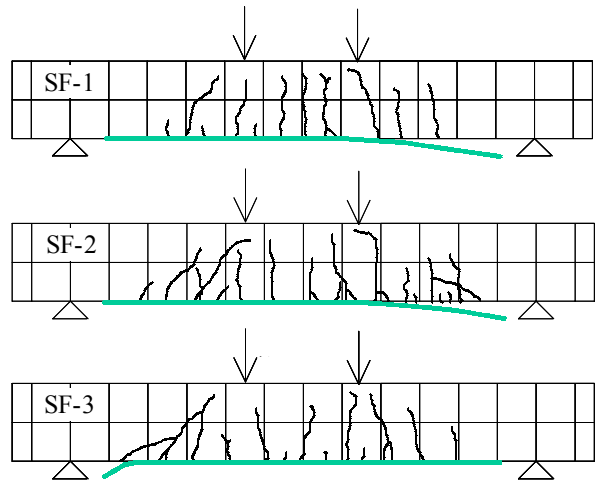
ひび割れおよびシート剥離状況 (終局時)
